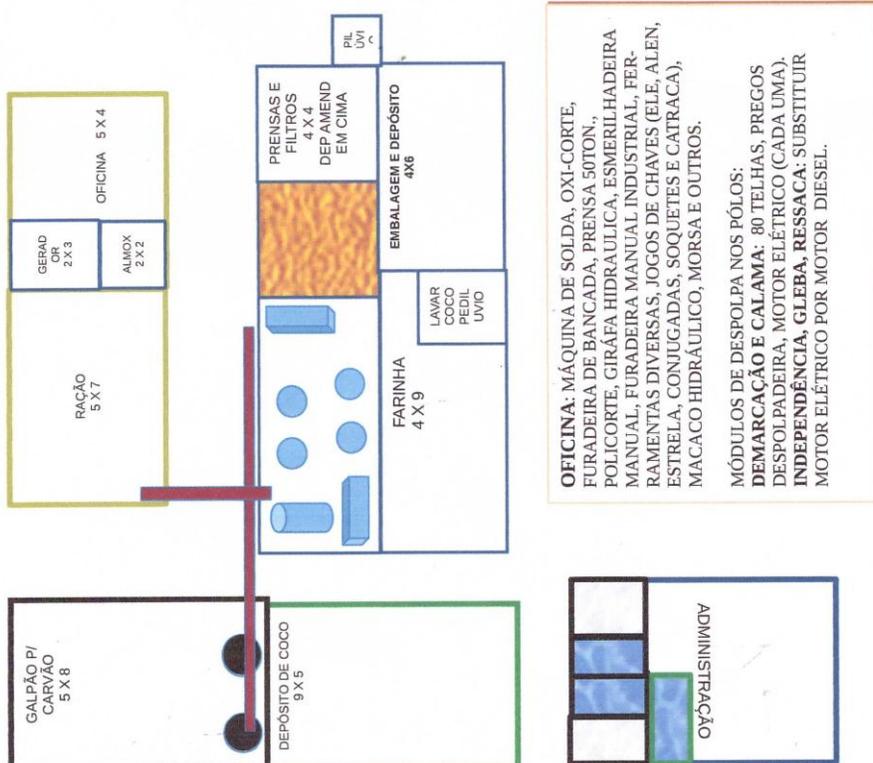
Layout da planta da agroindústria elaborado após a reunião de apresentação da planta baixa elaborada pelo engenheiro civil.
